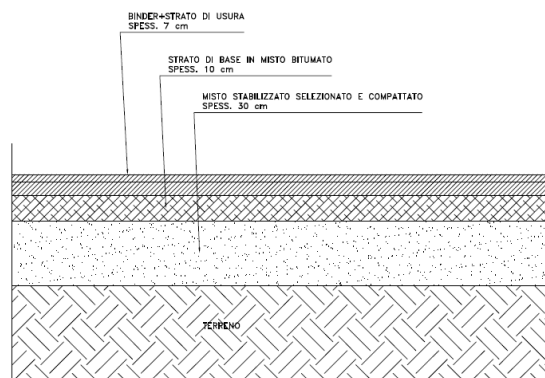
Via Fontanelle – Particolare pavimentazione
